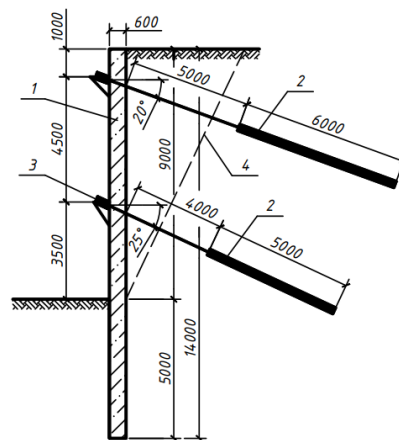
Грунтовая анкерная крепь: 1 – ограждение; 2 – грунтовый анкер; 3 – продольный пояс; 4 – призма сдвига
